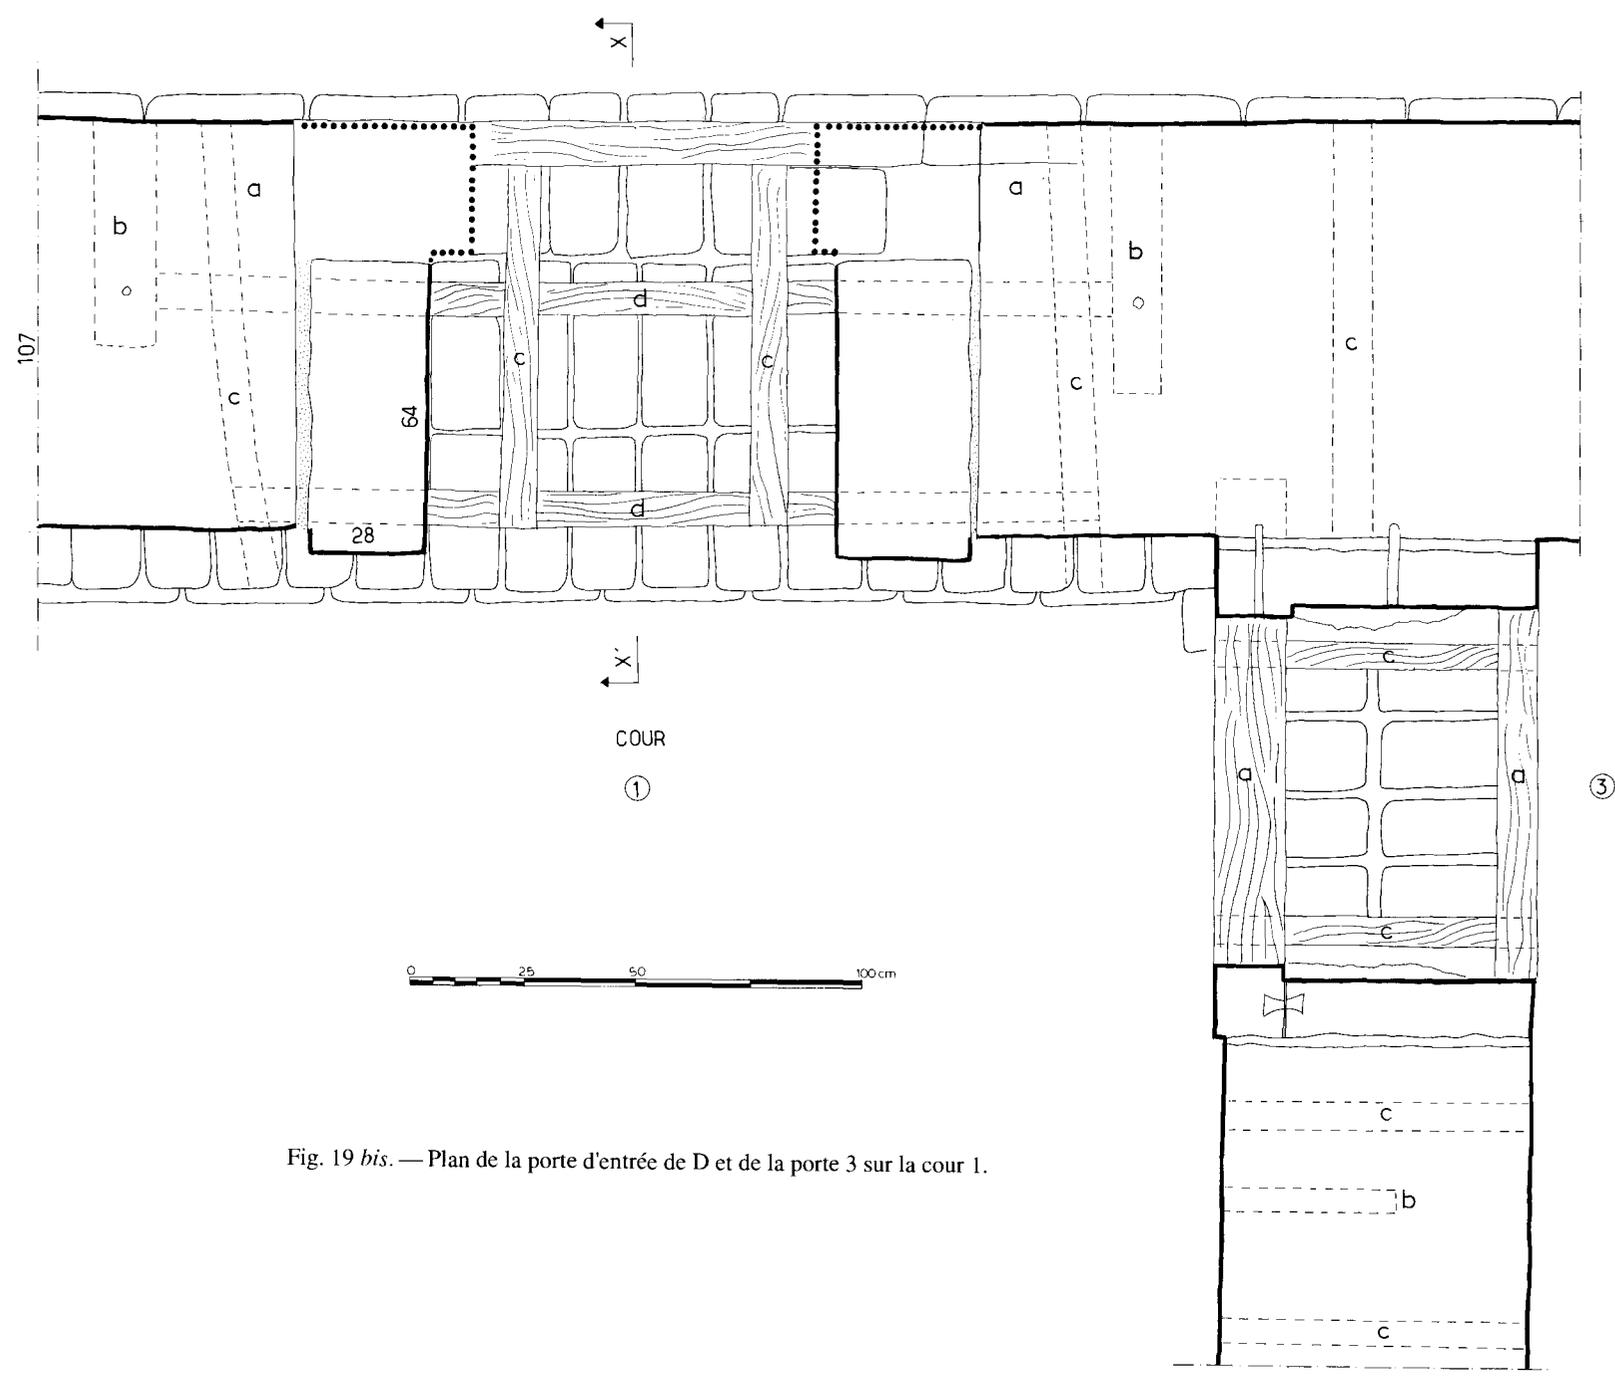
bis. — Plan de la porte d'entrée de D et de la porte 3 sur la cour 1.
